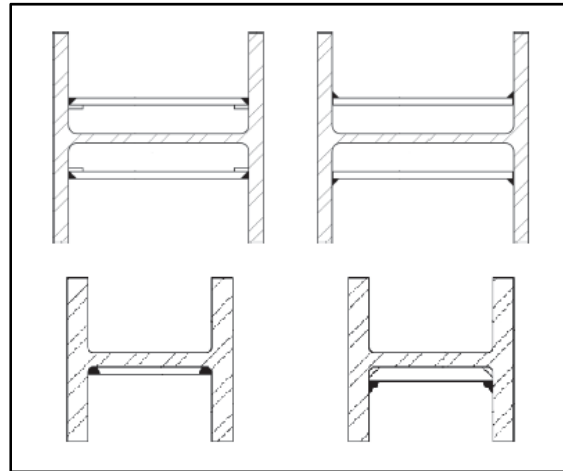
Refuerzo de la Zonal del Panel. Adaptado del AISC – 341
